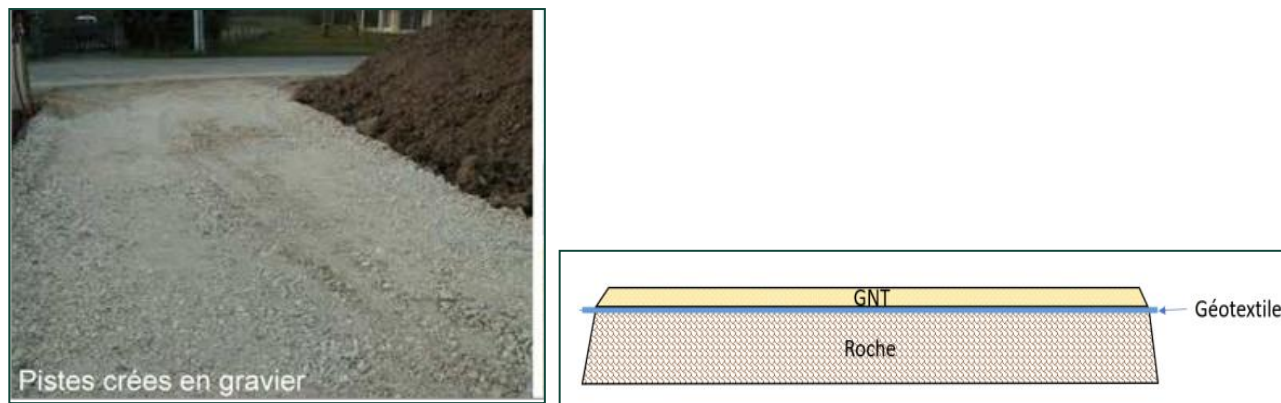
Exemple de piste créée en gravier et plan de coupe
